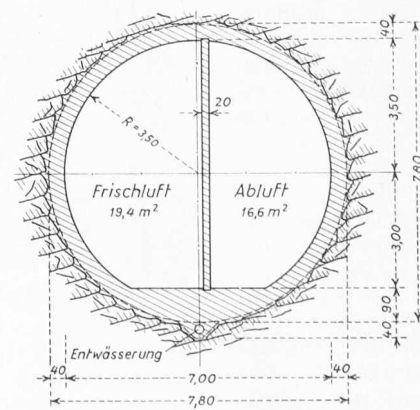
Lüftungsschraßschacht, Normalprofil 1:200
